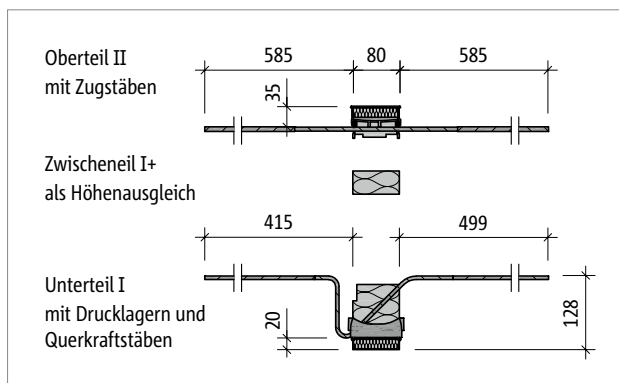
Schöck Isokorb® T Typ KL-F M1 bis M7-V1/V2
